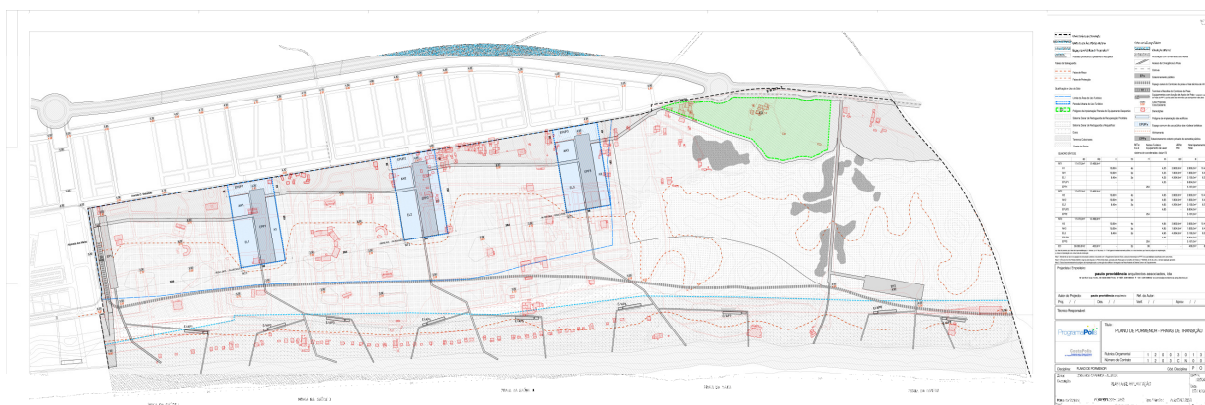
Planta de implantação do Plano de Pormenor 5 Praias de Transição, disponível em <http://www.costapolis.pt/>, acedido em 13/03/2010.
